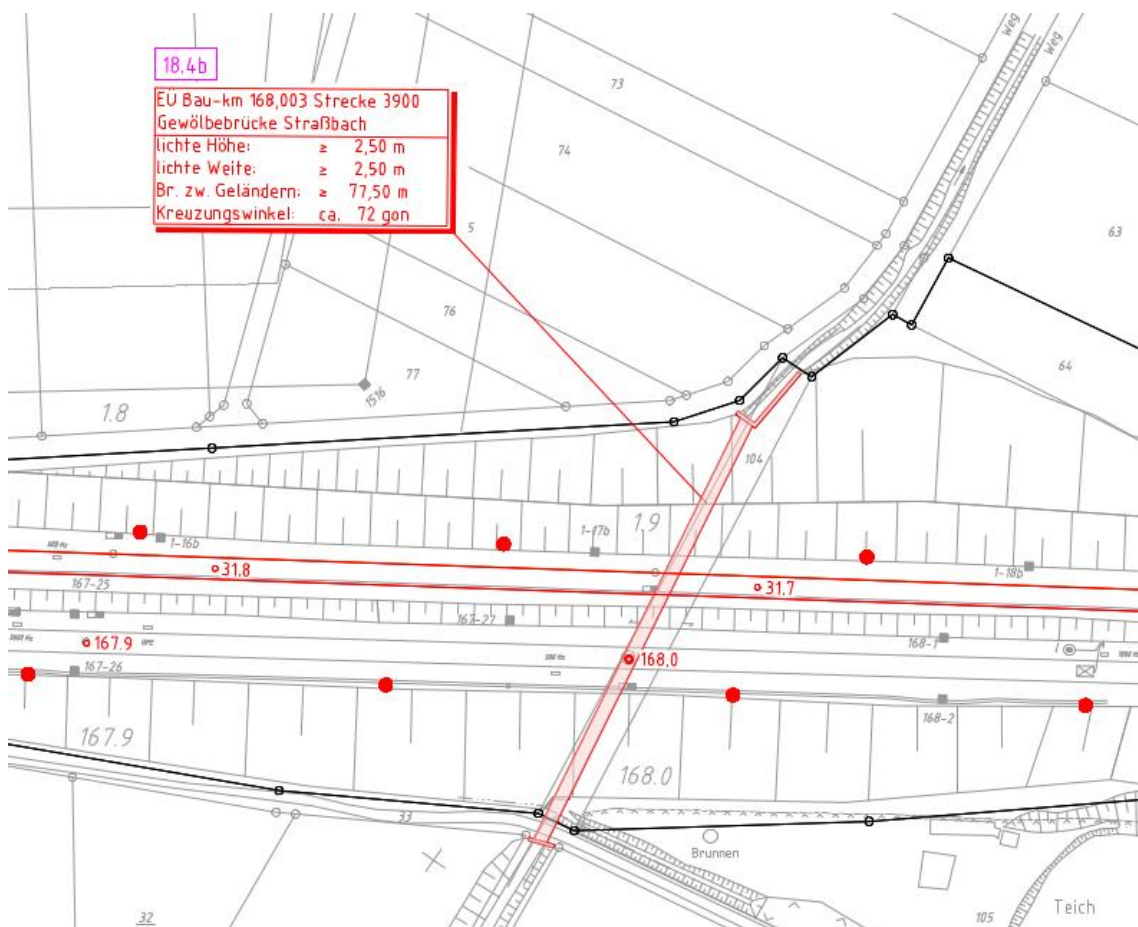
Lageplan des Kreuzungsbereichs OWK Straßbach und Bahntrasse
